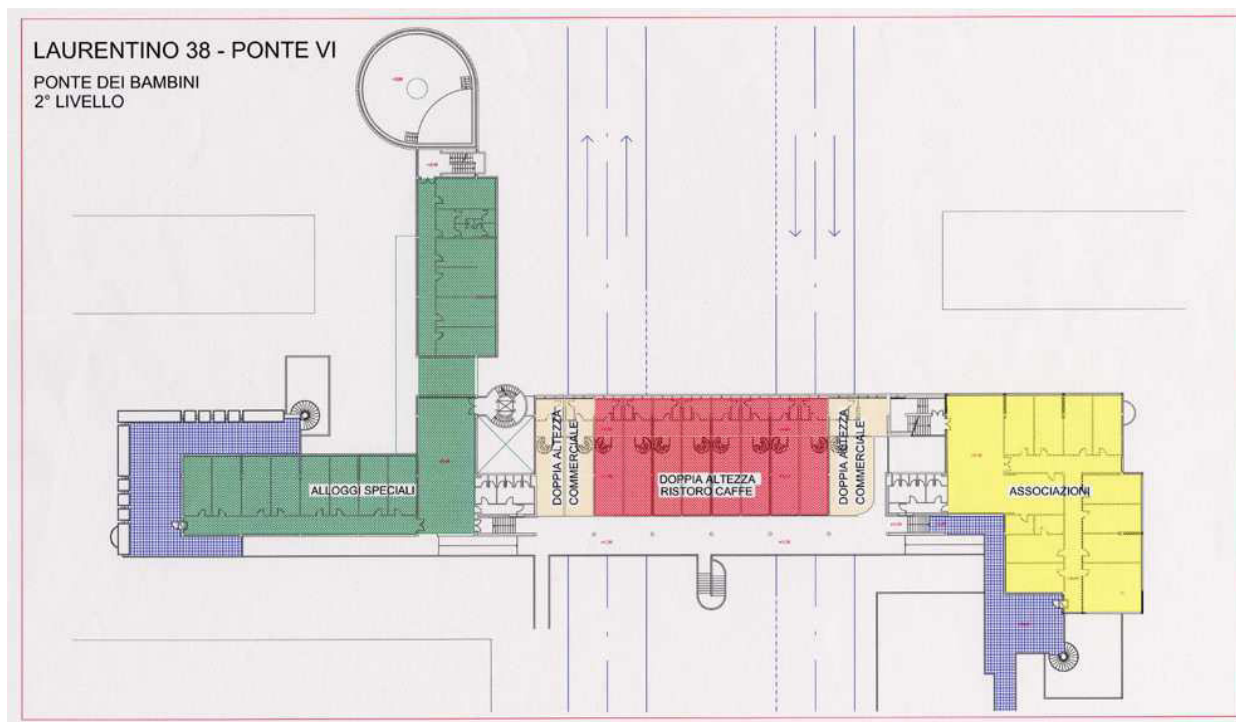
Il progetto di recupero di un ponte: il ponte dei bambini
